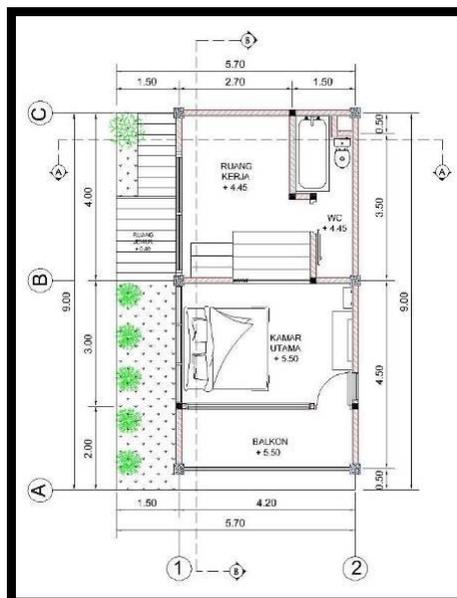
Denah Lantai Mezzanine Type 80 Perumahan Compact House di Iklim Tropis Kota Pontianak
